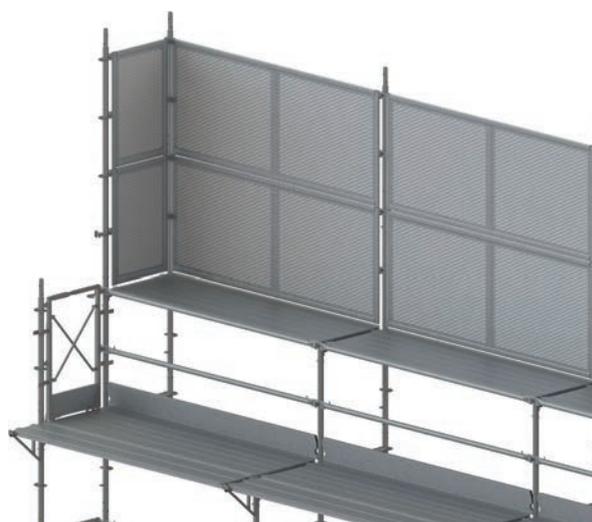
Pont de couvreur et grille de couvreur, grille latérale.
